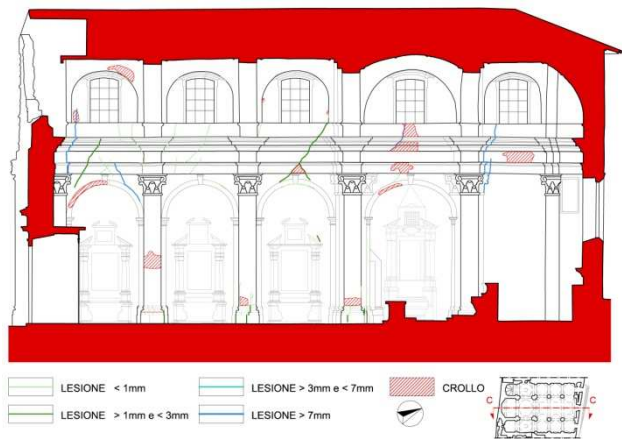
Quadro Fessurativo: sezione C-C'
